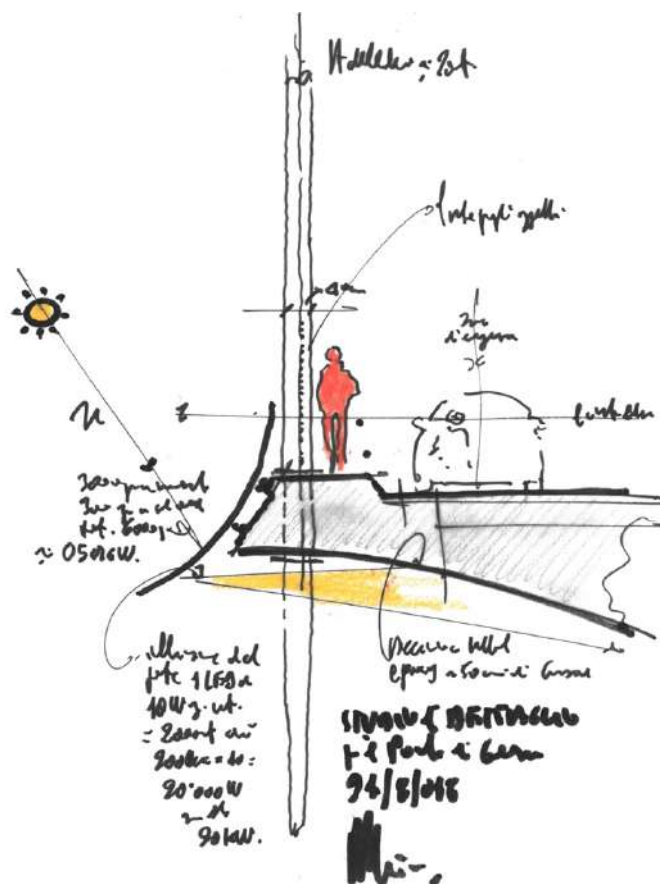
Croqui do sistema fotovoltaico. Fonte: Renzo Piano Building Workshop
